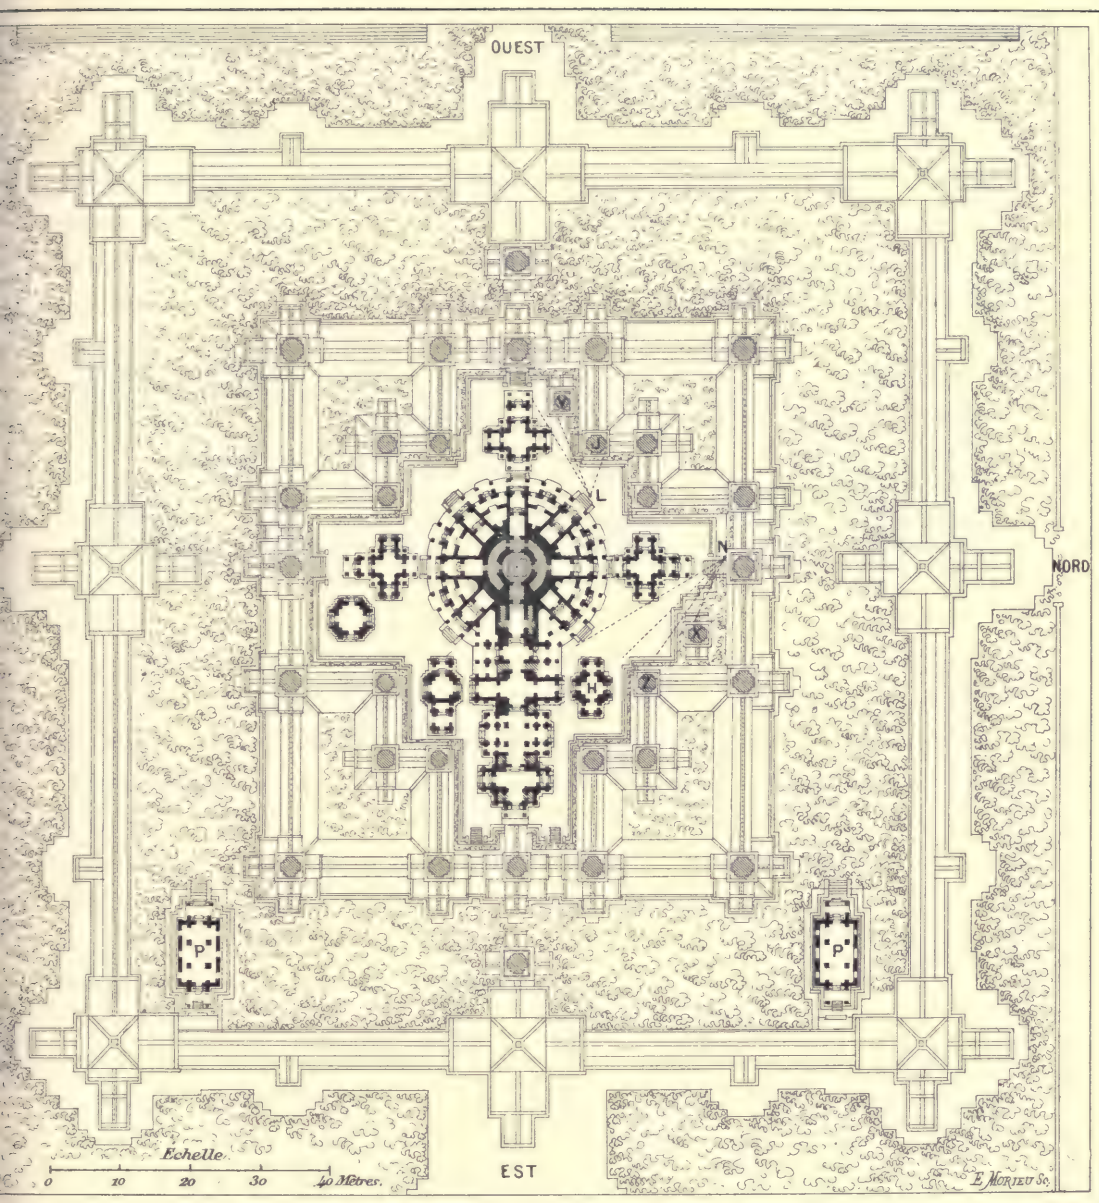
Plan général de la troisième et dernière terrasse du Bayon.
